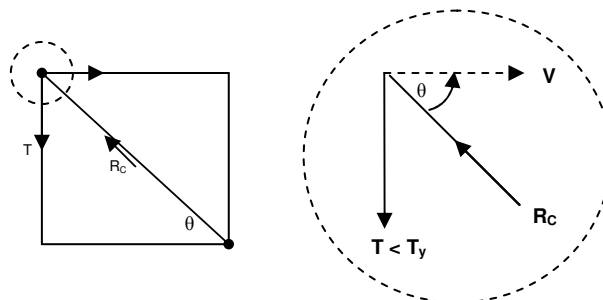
Equilibrio en nudo superior de muro de albañilería confinada modelado como un sistema puntal-tensor.
